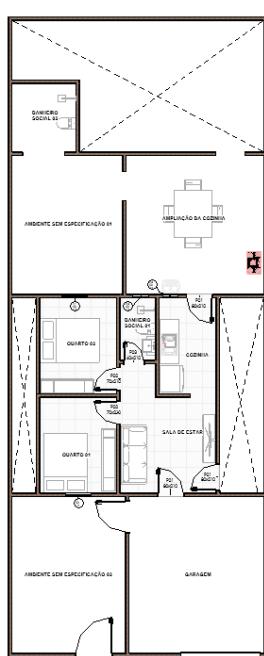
Croqui planta baixa edificação com as ampliações realizadas.
